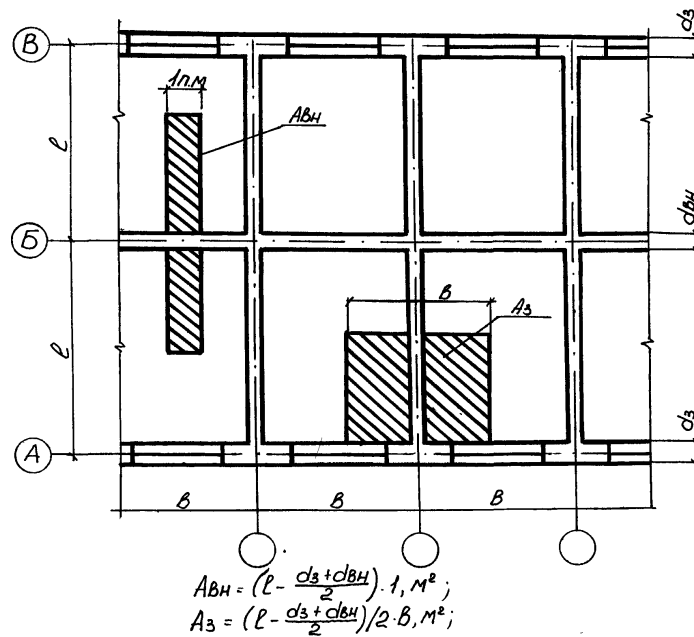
Схематичний план будівлі та вантажні площі для розрахункових фундаментів
